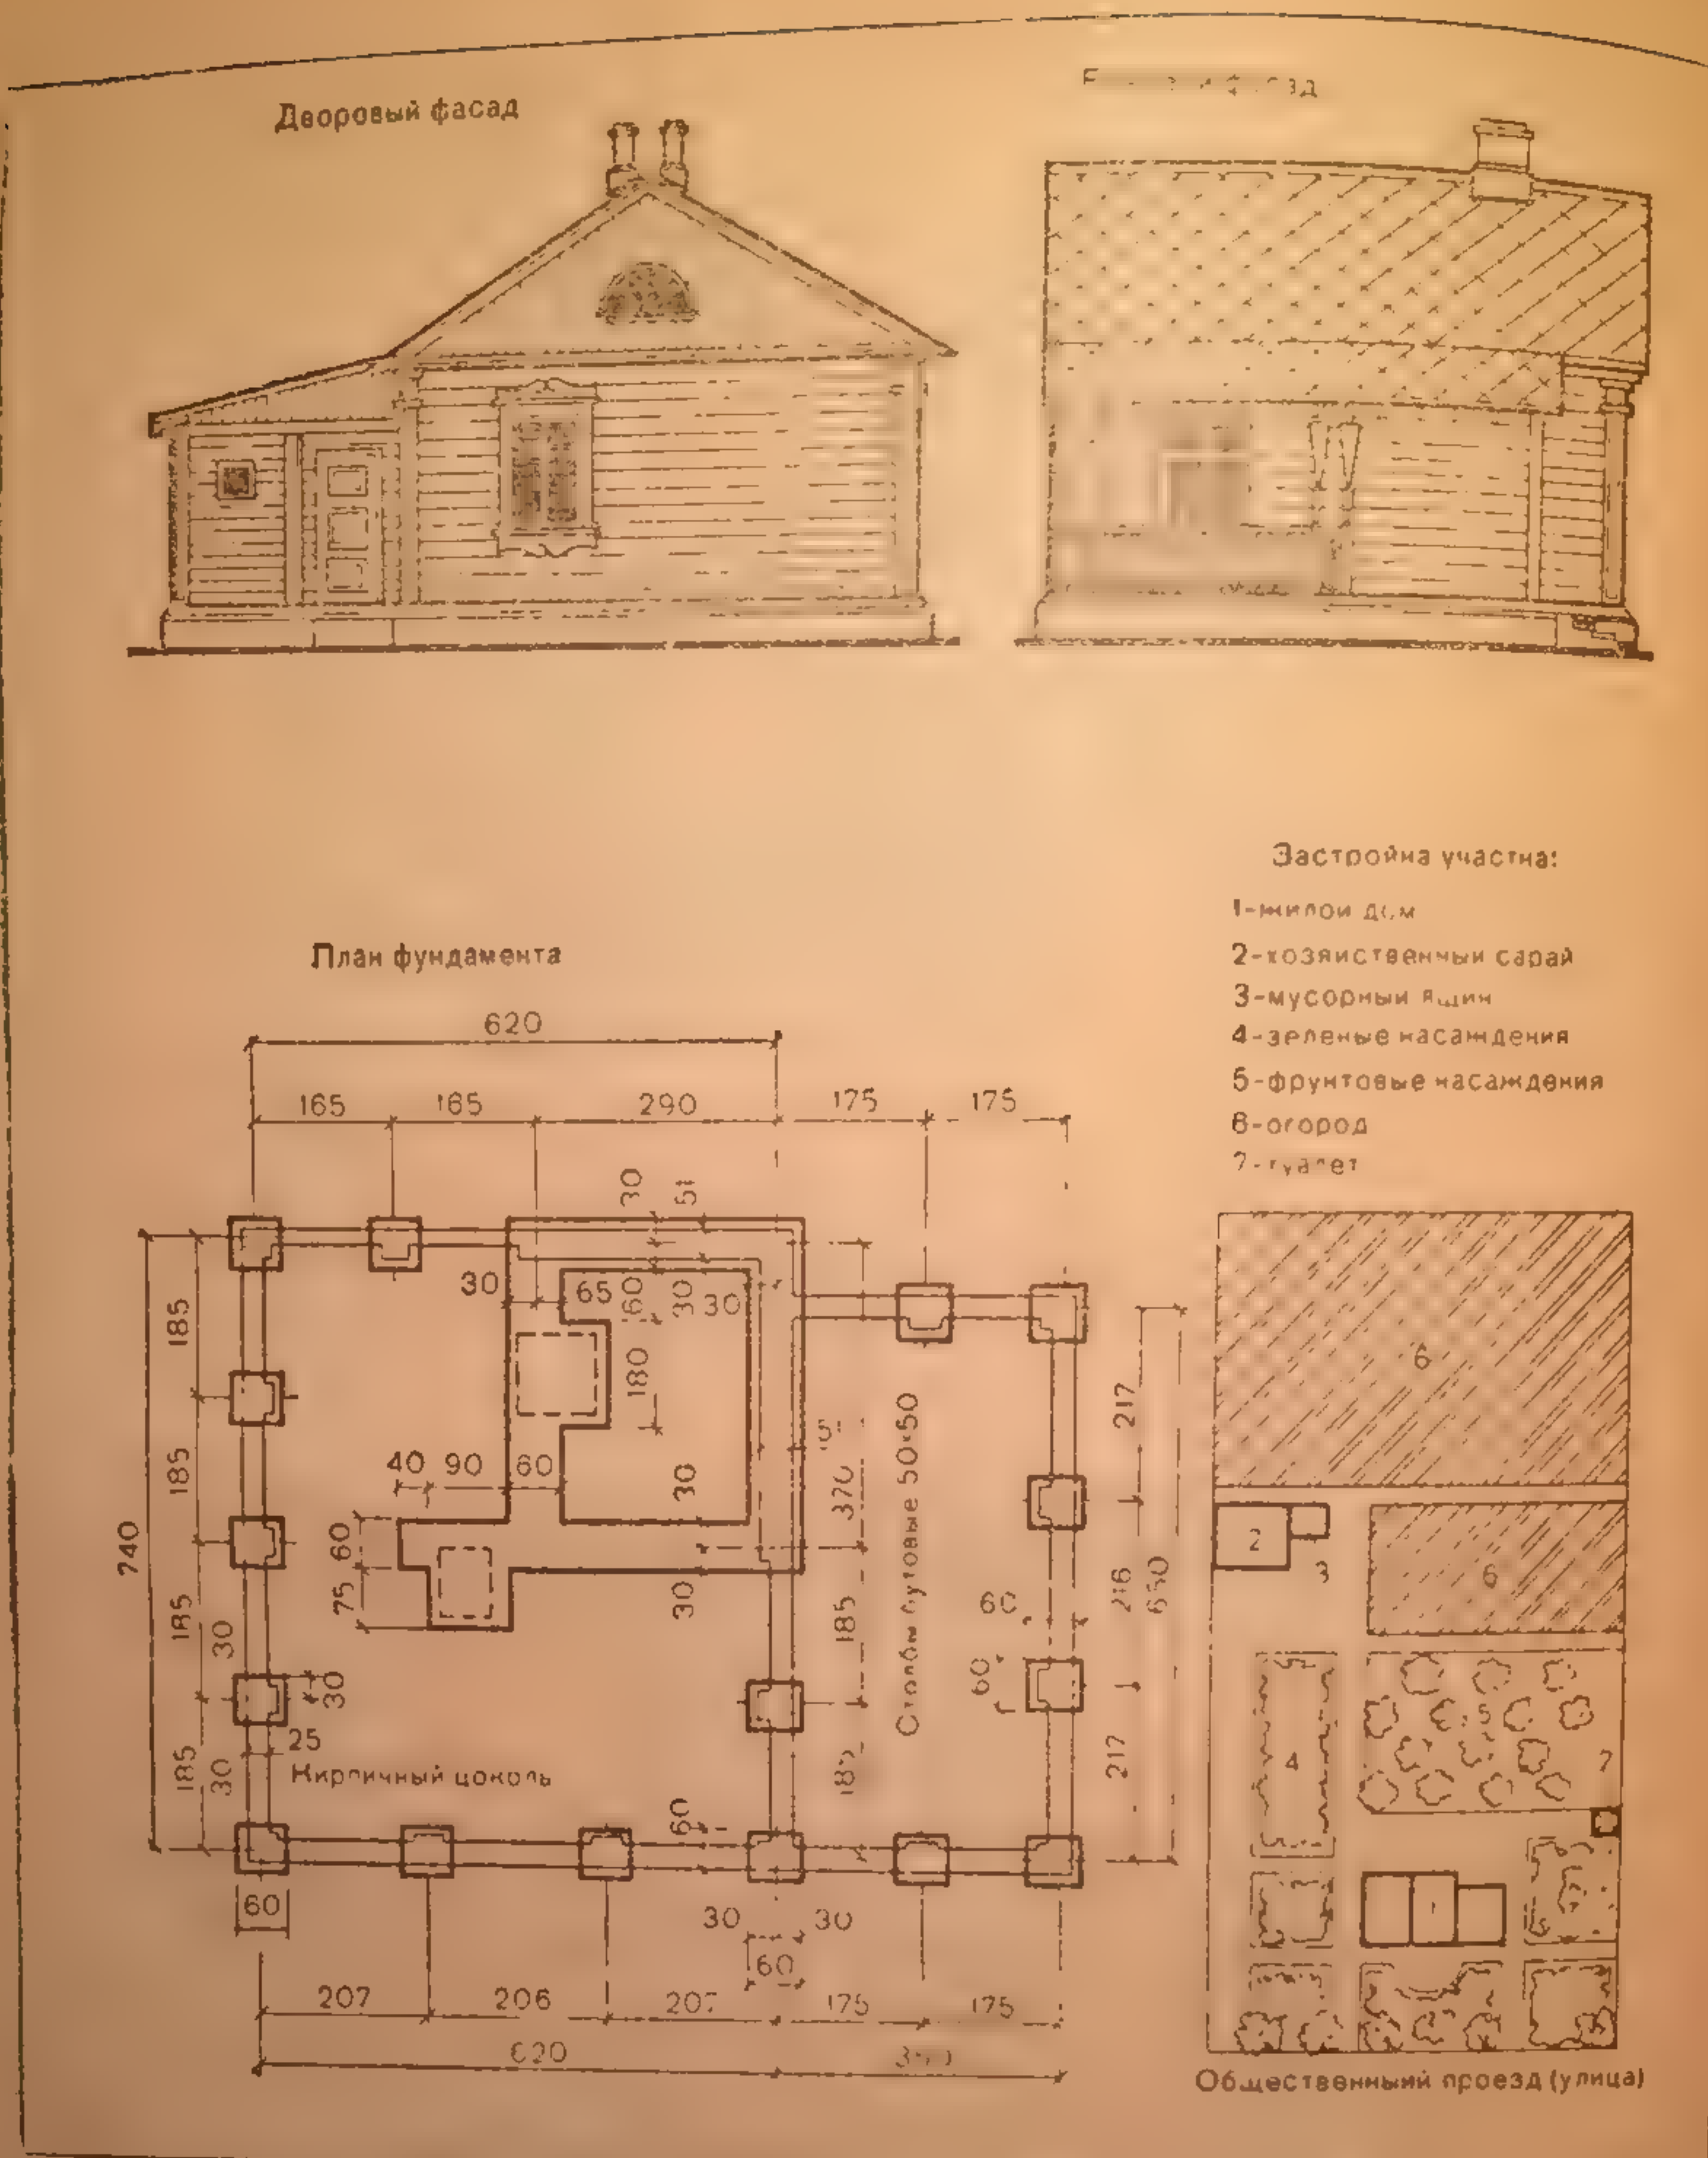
Дворовый и боковой фасады, планы фундамента и участка (размеры в см)
